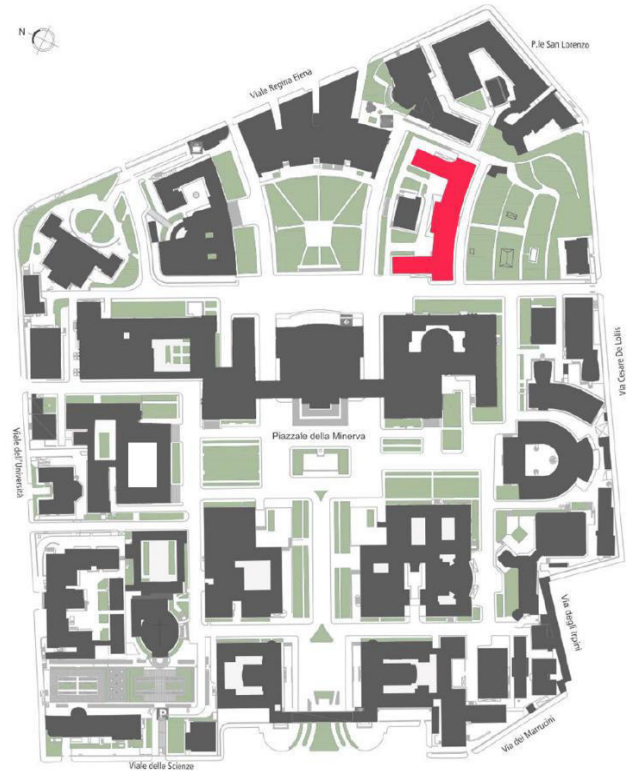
Planimetria generale della città universitaria ed individuazione dell'Istituto di Botanica.
